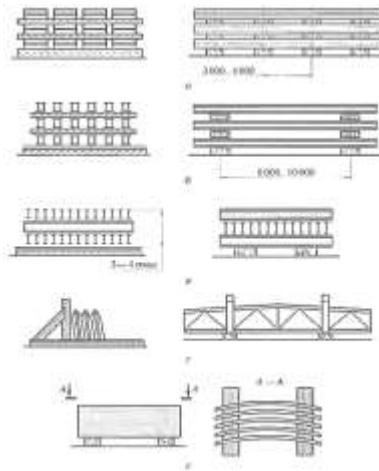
Складирование стальных конструкций: а — балок и колонн плашмя; б — двухстеночных элементов; в — балок в вертикальном положении; г — фермы в полнаклонном положении; д — свальцованных листов
